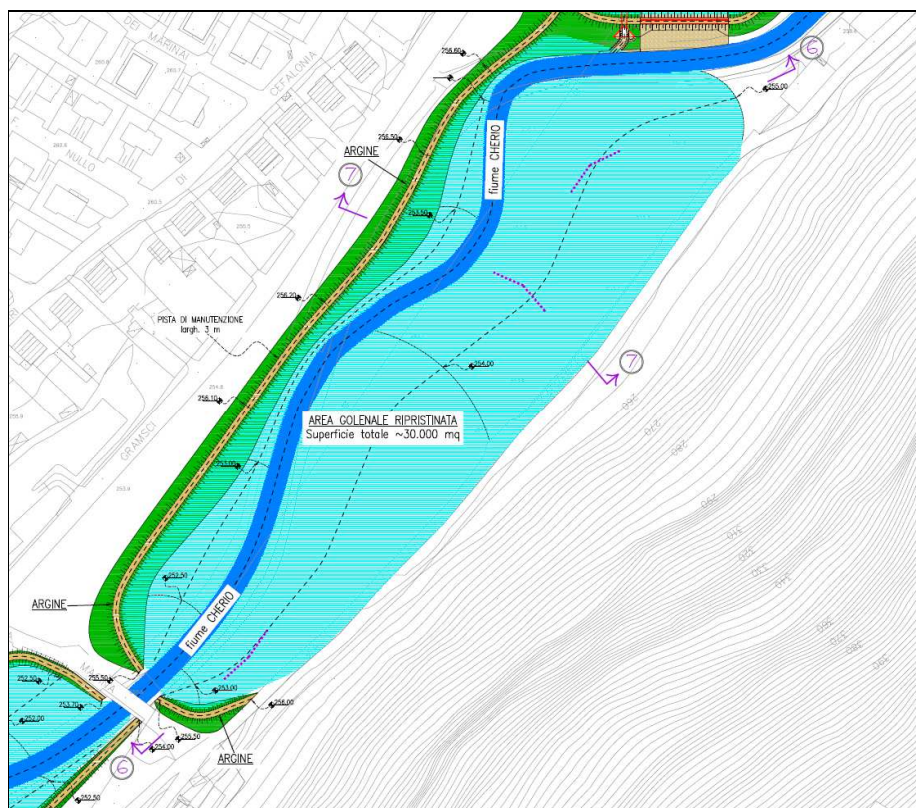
Planimetria dell'area di espansione golenale "Macina"
